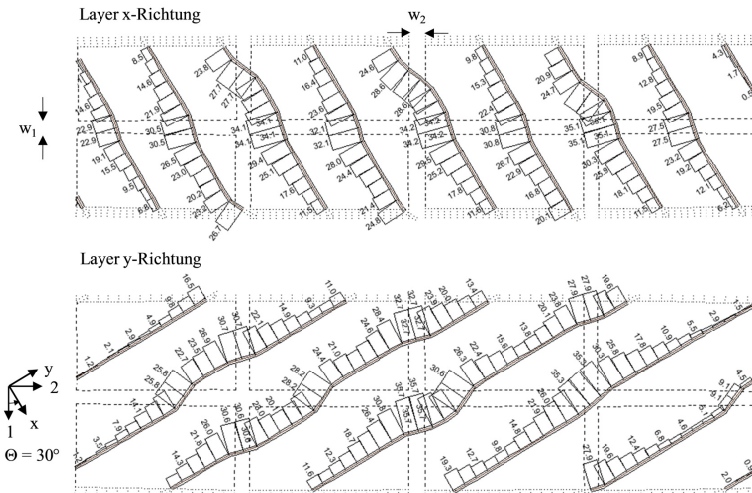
Stabnormalkräfte Bewehrung: (oben) x- und (unten) y-Richtung im Riss für $k = 1,0$, Verformungen 100-fach überhöht dargestellt
